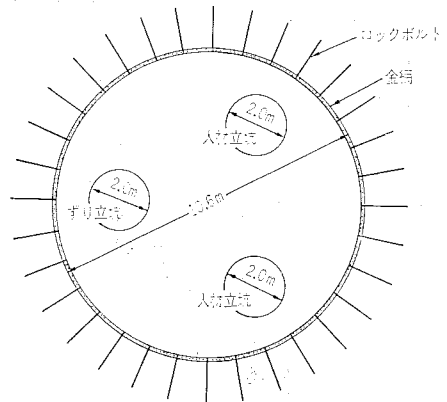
上向き全断面掘り上がり工法標準断面図（シート配置図）
